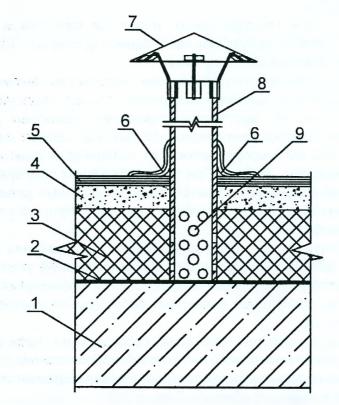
Схема установки аэратора на совмещенной кровле: 1-несущая конструкция; 2-пароизоляция (1 слой рубероида); 3-утеплитель (гравий керамзитовый δ=120 мм); 4-выравнивающая стяжка (δ=30 мм); 5-водоизоляционный ковер (4 слоя рубероида); 6-наплавляемый рубероид (два слоя); 7-металлический колпак (съемный); 8-аэратор (асбестоцементная труба Ø100 мм); 9-рабочая зона аэратора (отверстия Ø10 мм с шагом 20 мм)
